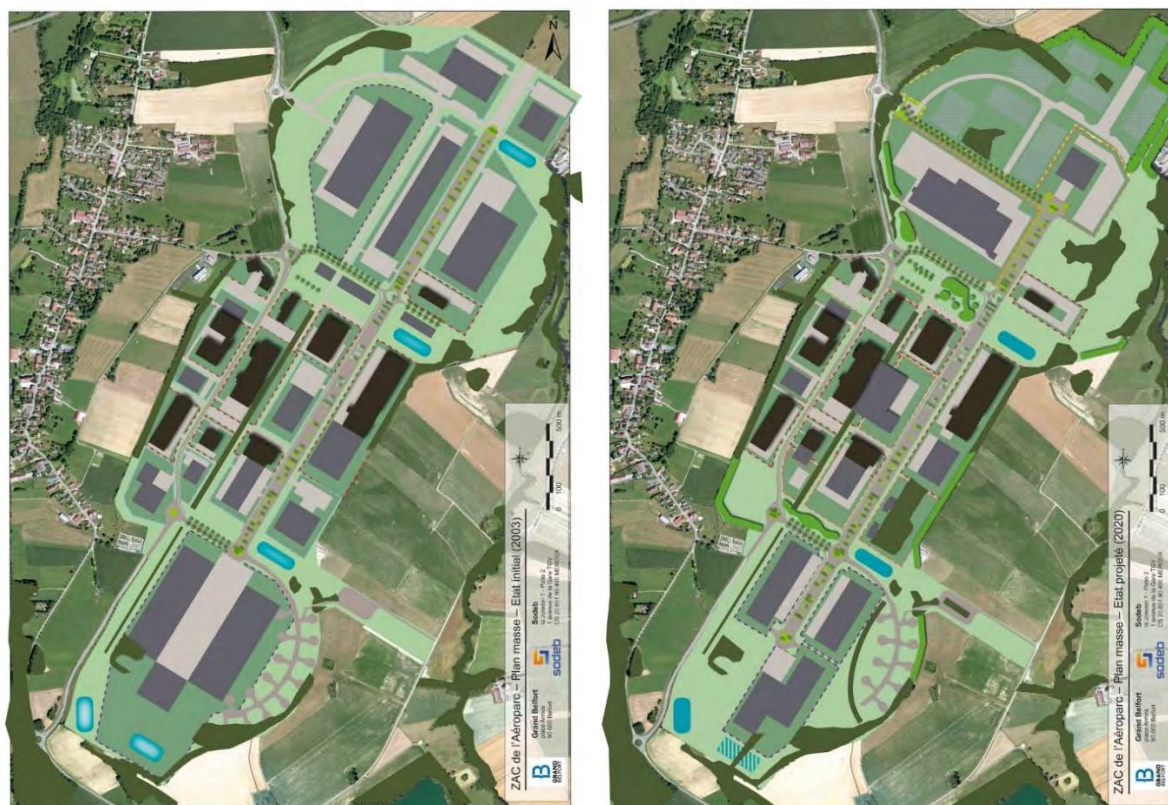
Plans d'aménagement de la ZAC prévu en 2004 et nouveau plan parcellaire proposé en 2020
